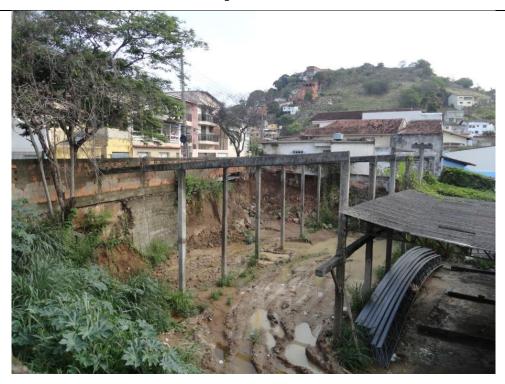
Escavações em terreno deixando parte da Avenida Maruipe e moradia em risco.
